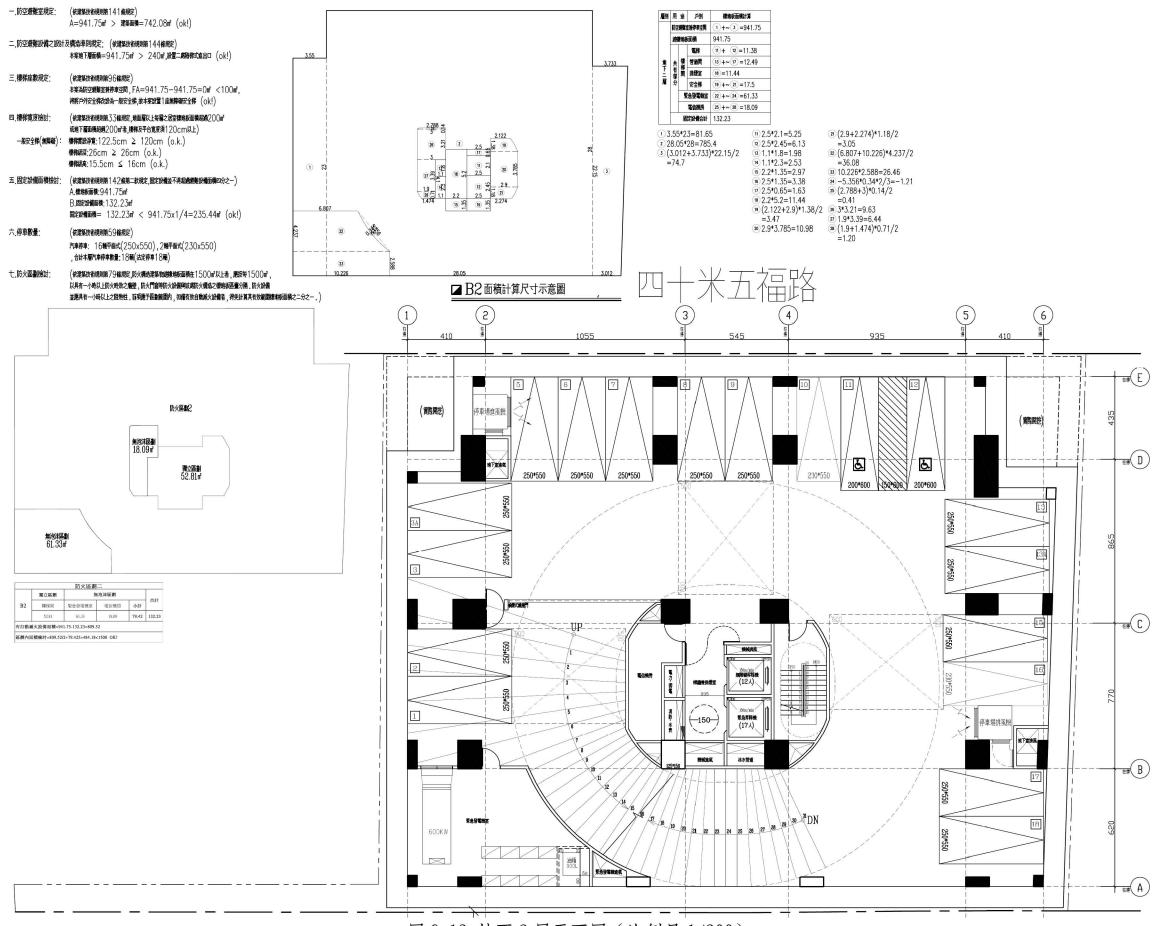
地下 2 層平面圖 (比例尺 1/200)
